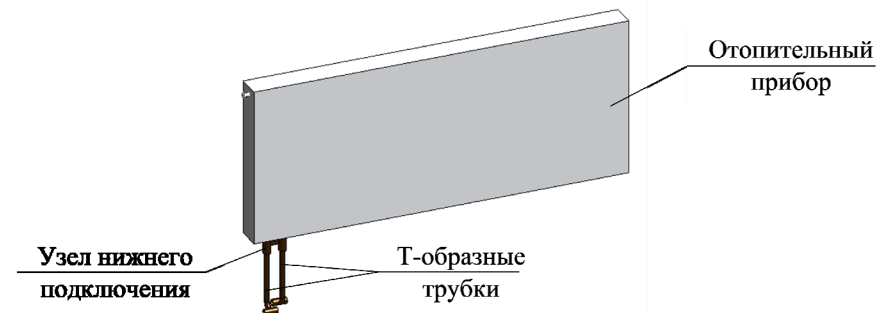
Семейство отопительного прибора с Т-образными присоединительными трубками
